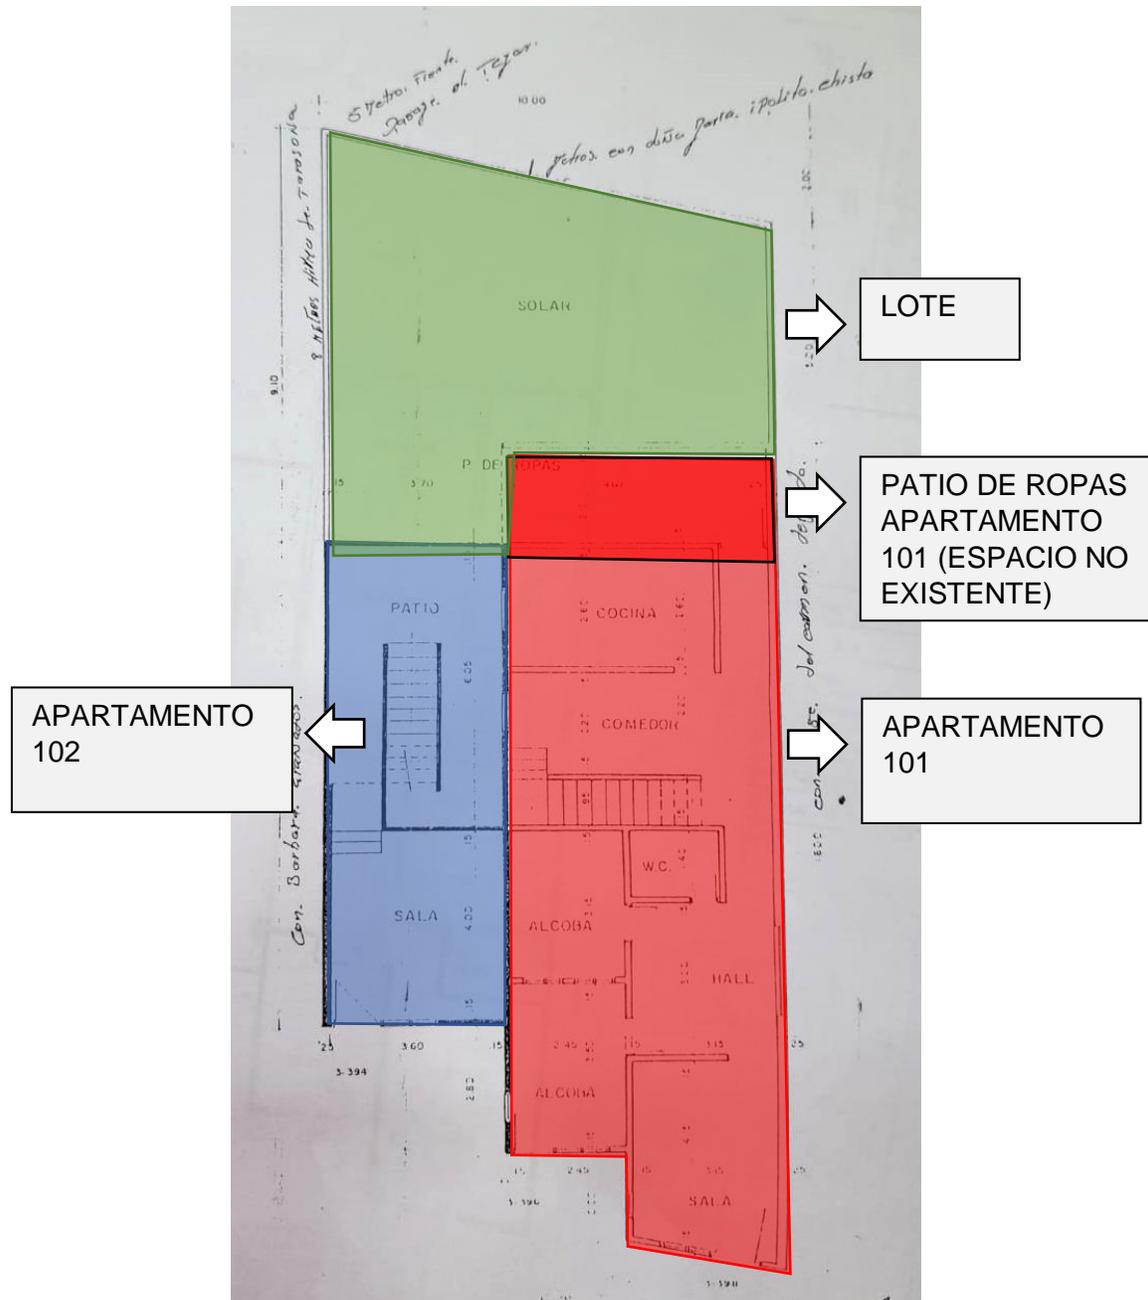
Planimetría primer piso, lote general. Fuente: Escritura pública No 899
